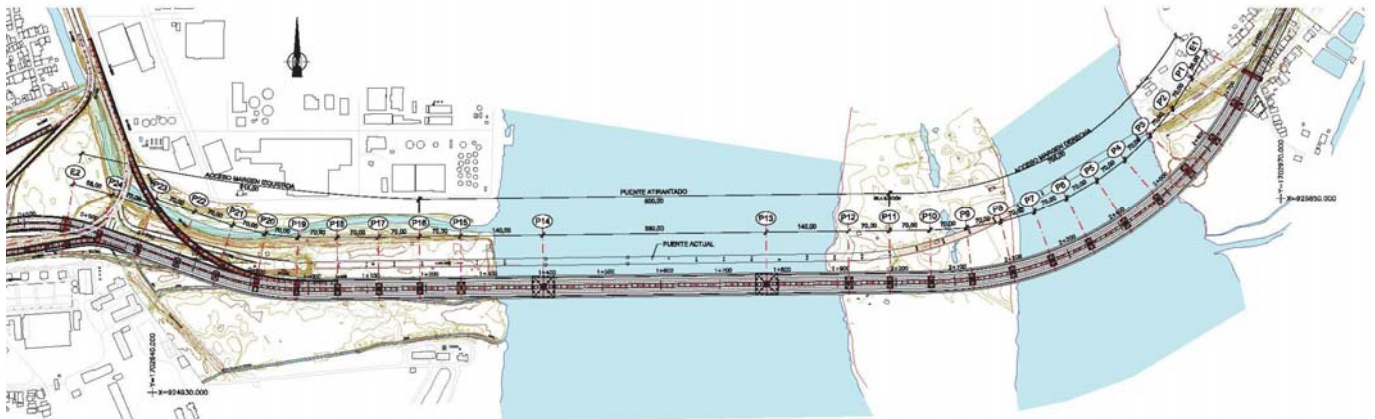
Planta general de la estructura del Nuevo Puente de Pumarejo
